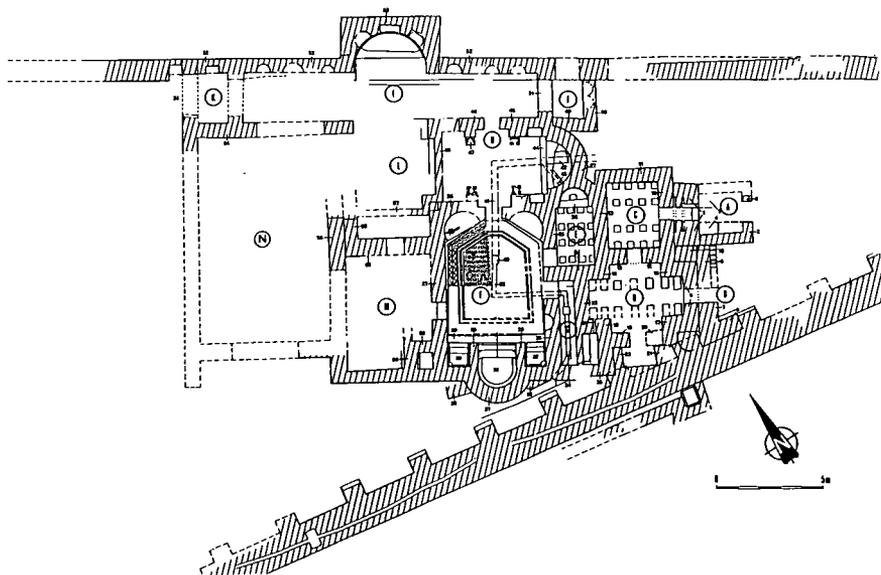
Planta del edificio termal. Denominación de espacios y estructuras
